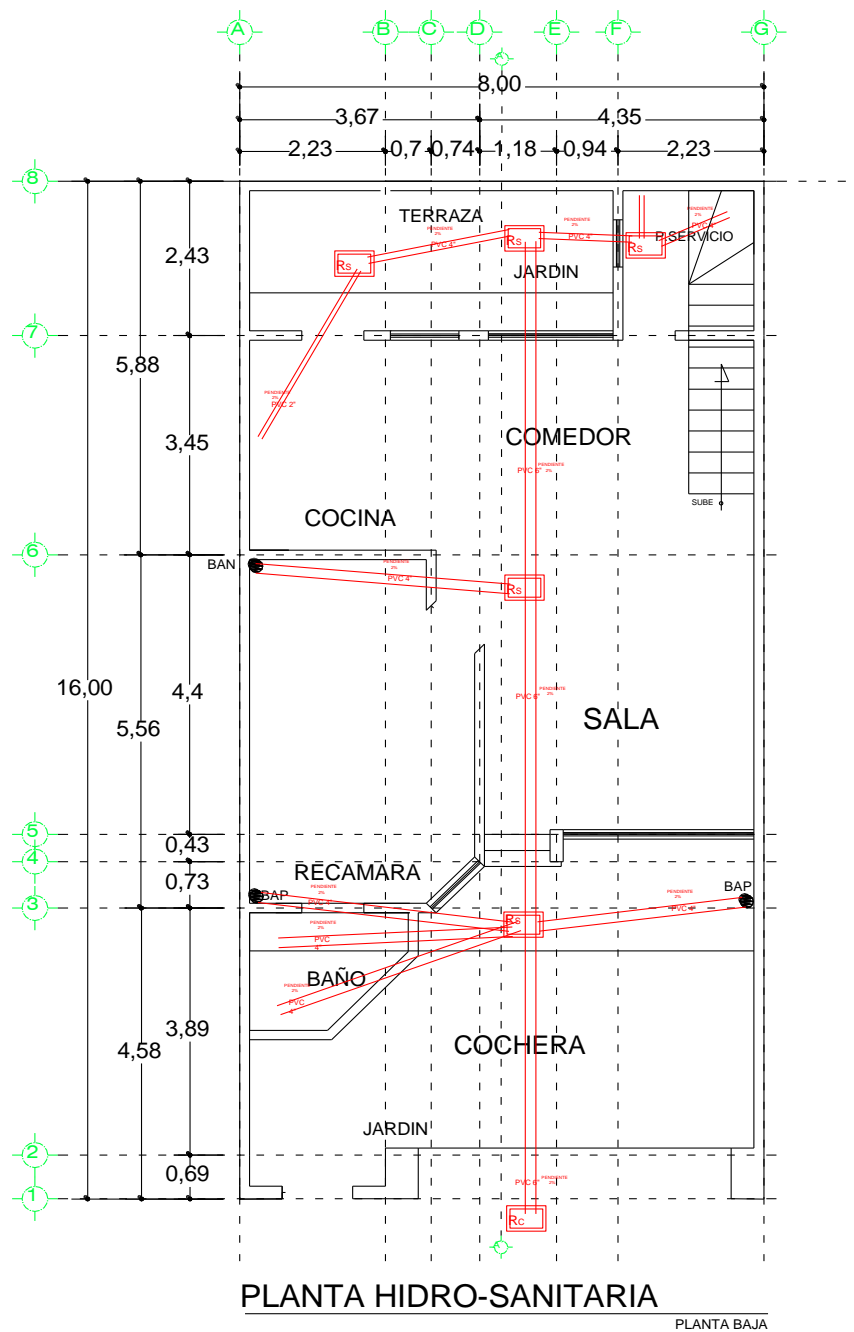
Planta baja hidro-sanitaria planta baja.
